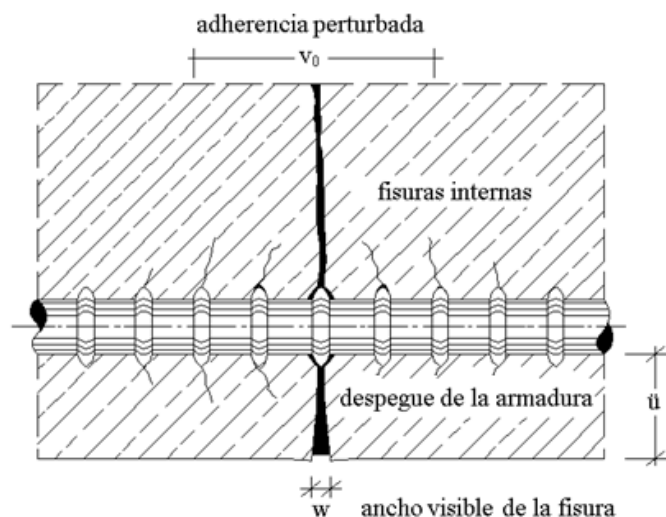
38. Pérdida de adherencia en la proximidad de las fisuras.
